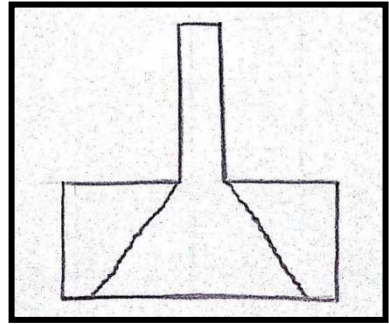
Punzonamiento en zapata o losa. Fuente: Propia.
